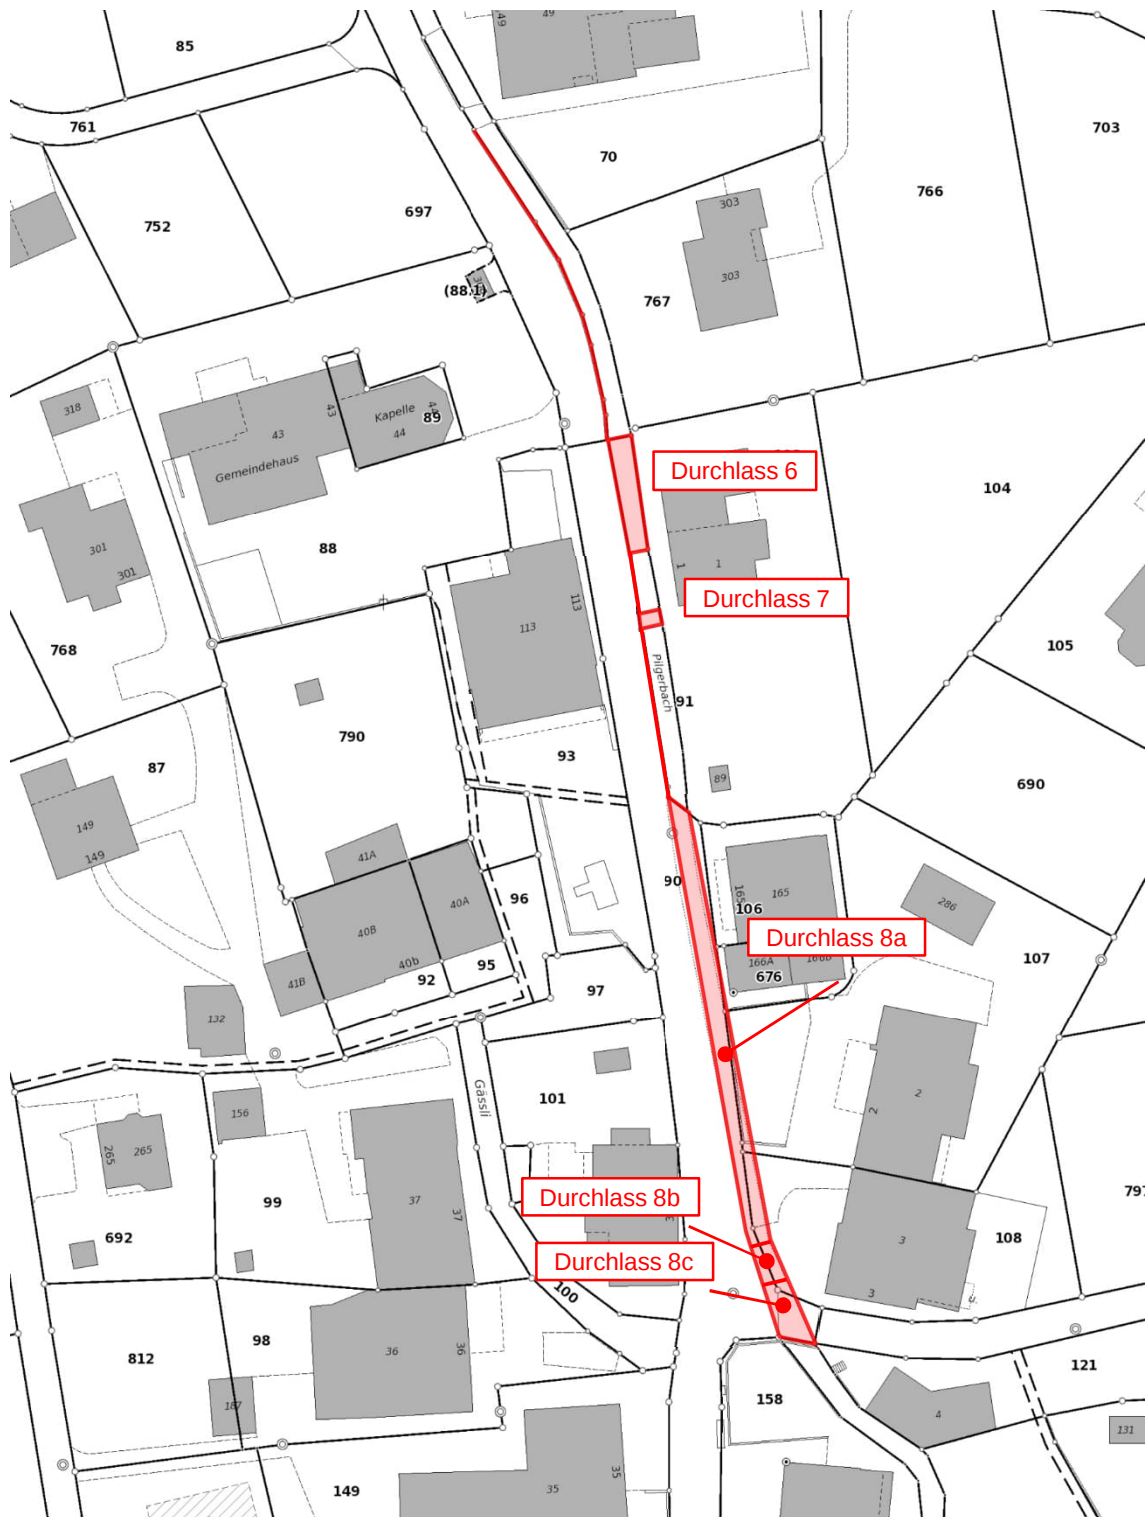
Lageplan mit Objektbezeichnungen (Teil 2/3)
